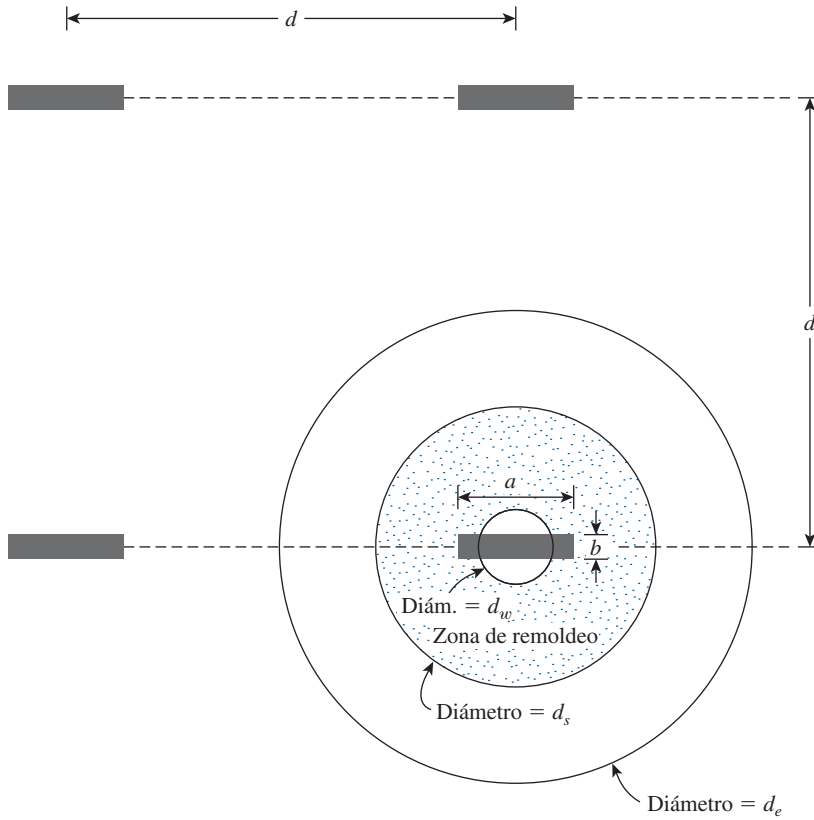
Configuración del patrón en red cuadrada de drenes prefabricados verticales
